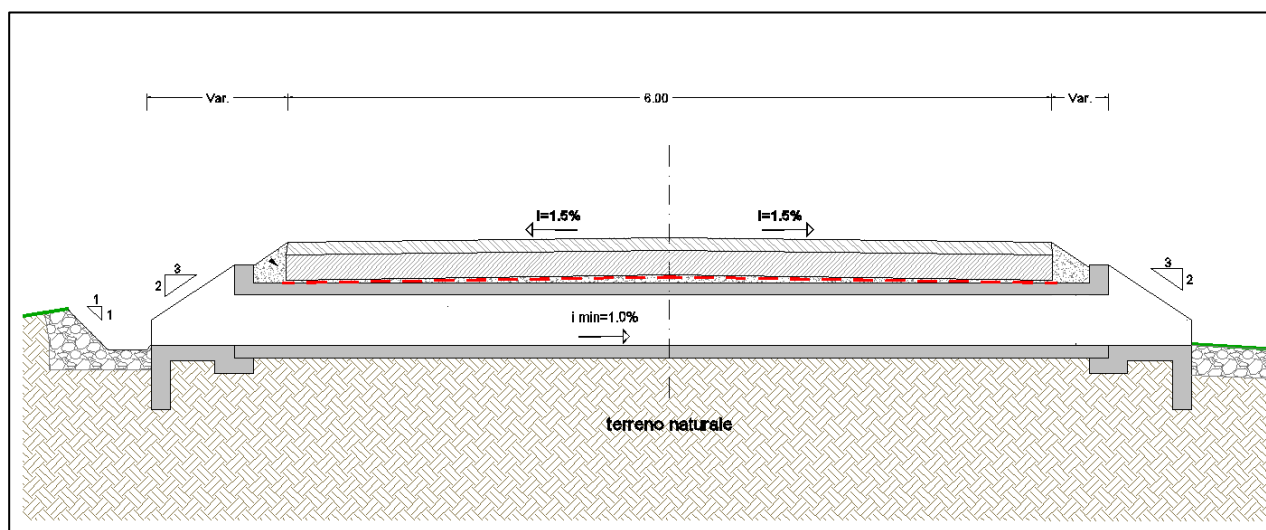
Sezione tipica di sezione stradale con condotta di attraversamento
